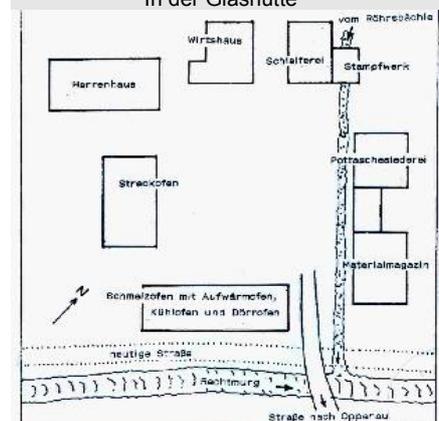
Plan der Glashütte Buhlbach um 1770 (nach einem Plan im HStAS, A248, B32425).
